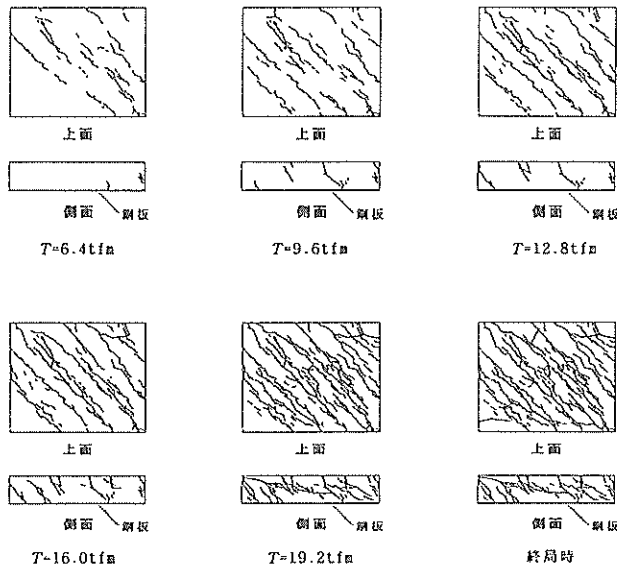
供試体 OS-19-100のひび割れ進展状況
